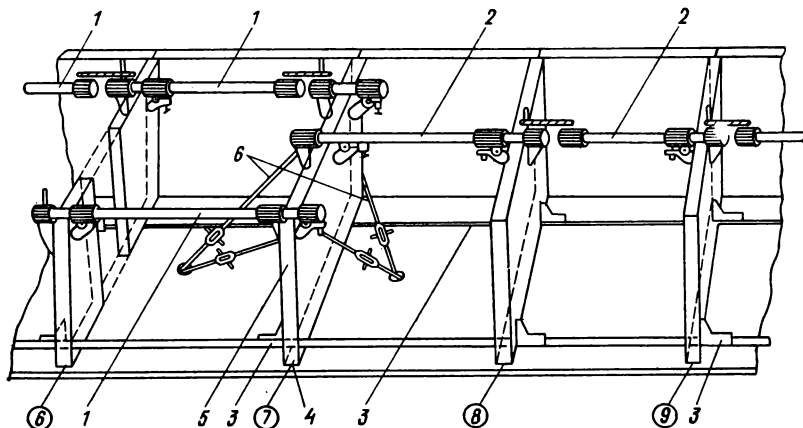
Монтаж стеновых панелей с помощью монтажной оснастки
